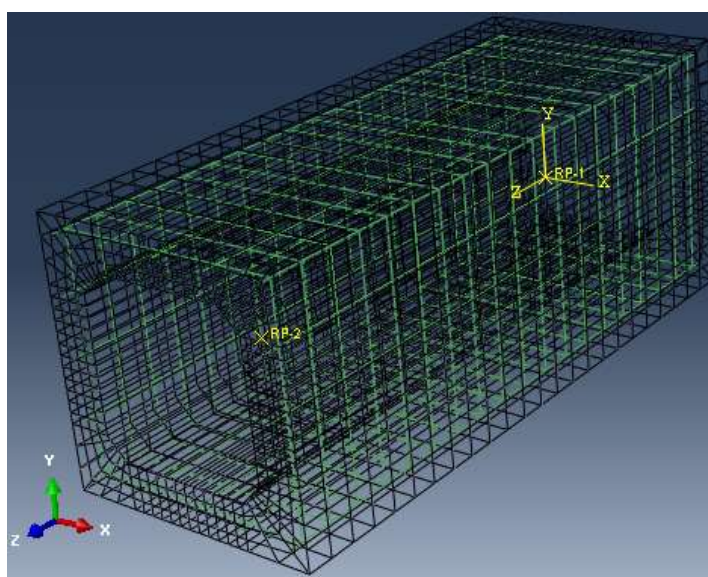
Colocação das armaduras longitudinais e transversais na sua posição no interior da viga
